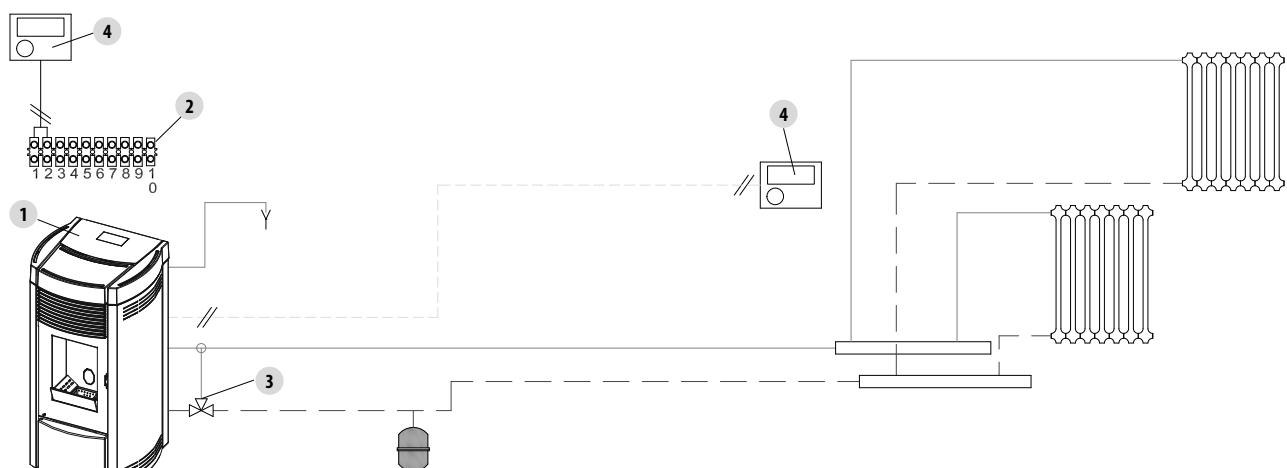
impianto con: stufa a pellet in diretta e termostato ambiente
